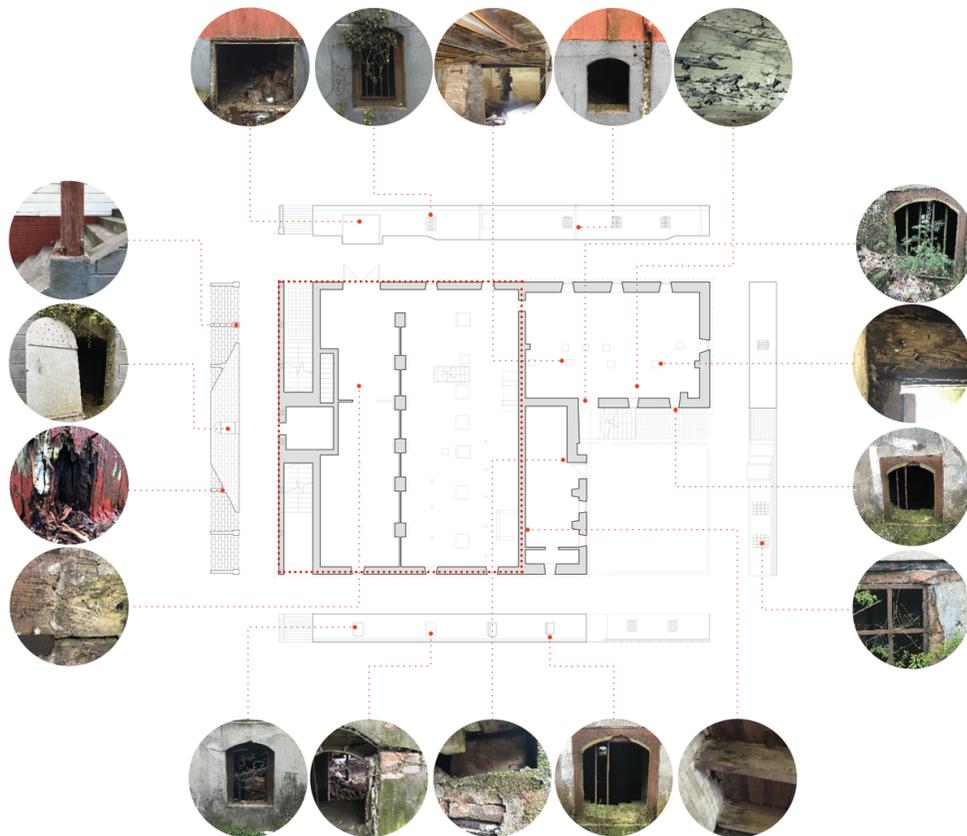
Planta nivel zócalo; el rectángulo rojo es el perfil original según Guarda (1980), (fuente: elaboración propia, 2022).
